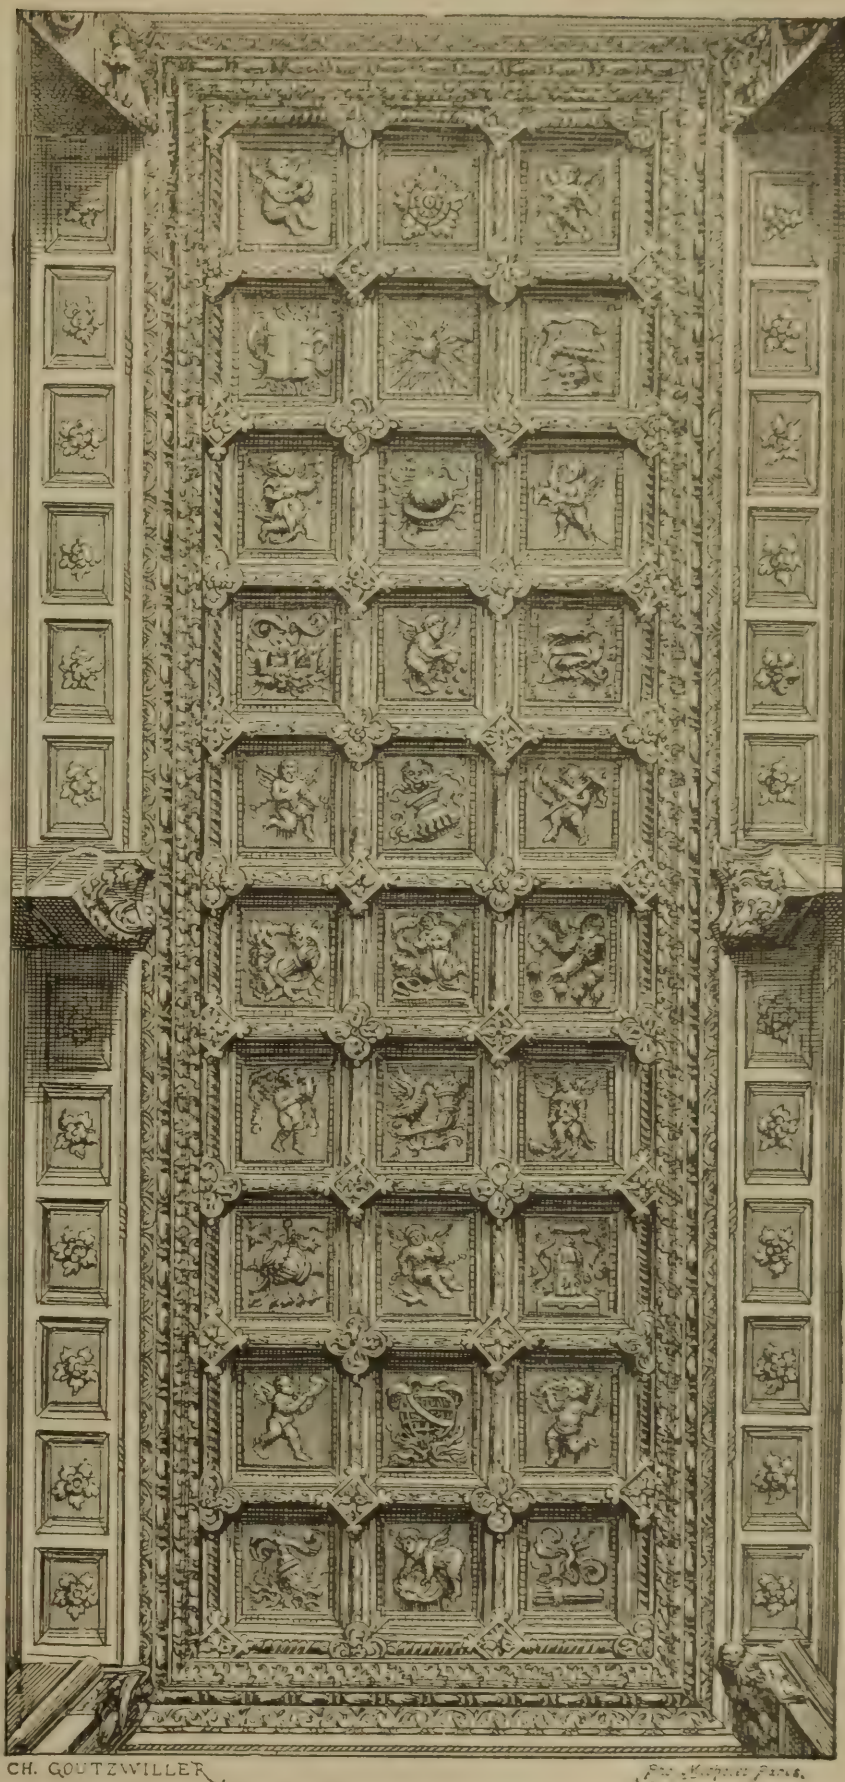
CAISSONS DANS UN PLAFOND DE STYLE RENAISSANCE
